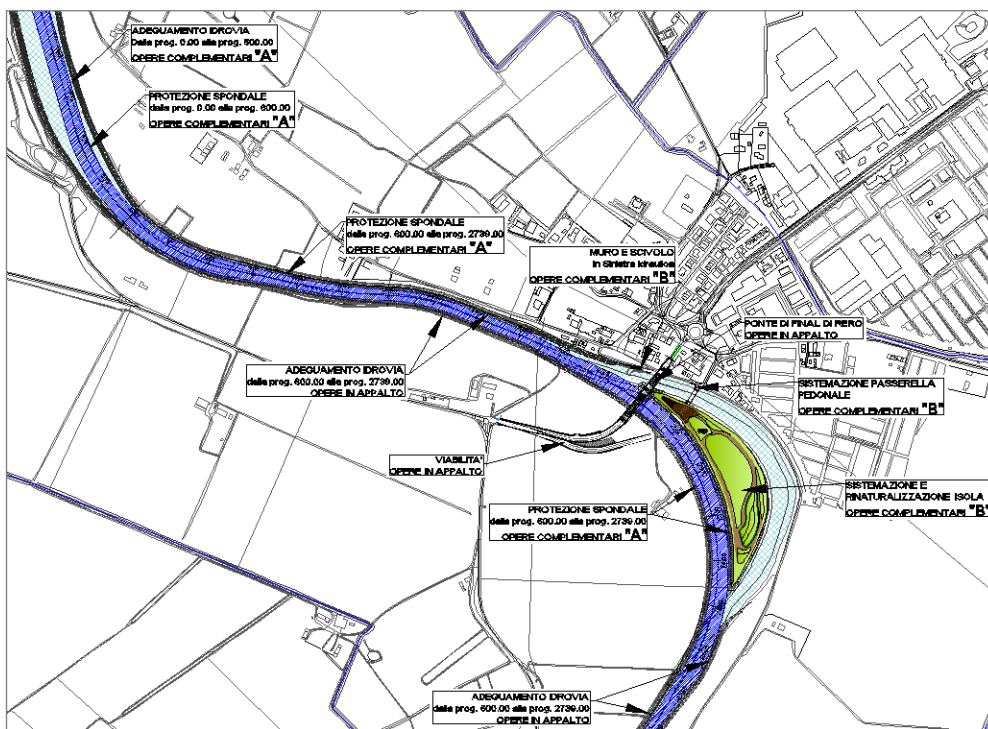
Rappresentazione planimetrica dell'area di intervento con indicazione delle parti d'opera appartenenti ai vari stralci di lavoro previsti
